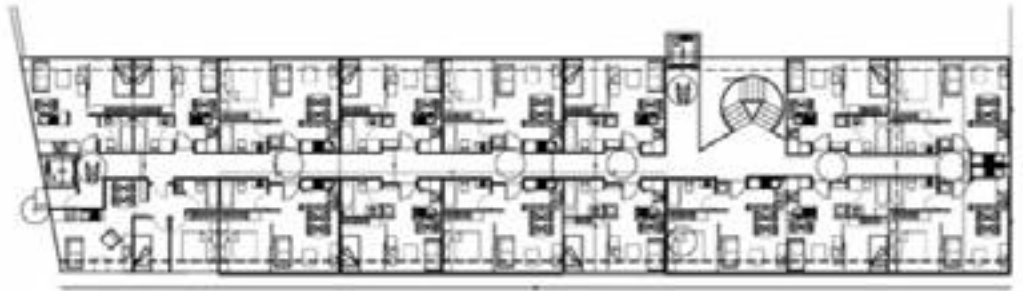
planta de suite junior del hotel NH en Monterrey. Foto int
